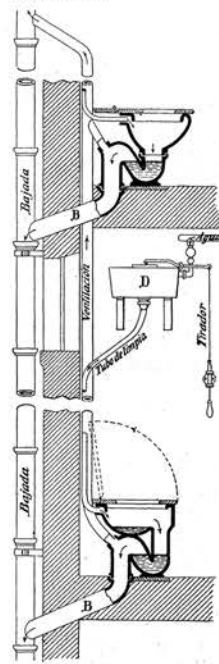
Conjunto de una instalación de retretes con sifón.
